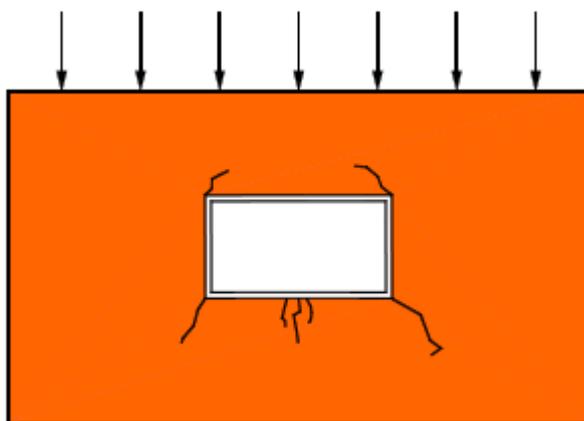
Fissuração teórica no entorno de abertura, em parede solicitada por atuação excessiva de cargas (Fonte: THOMAZ, 1989).
